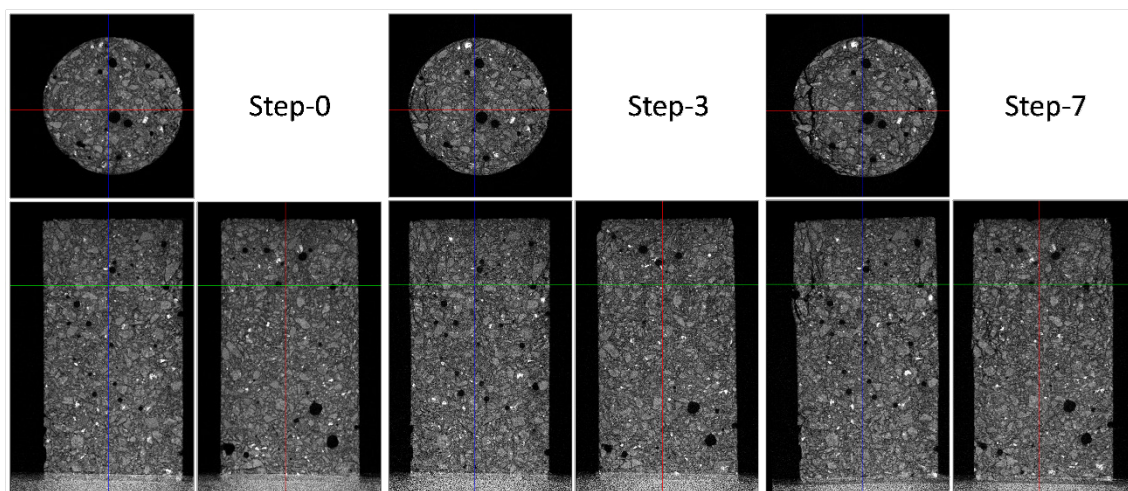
Evolución de las fisuras en 3 planos ortogonales entre si.
